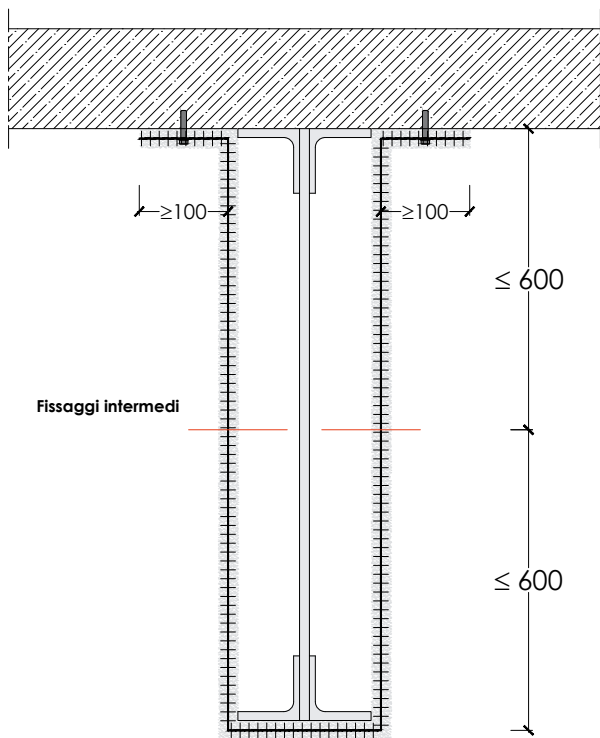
Schema di applicazione per protezione di trave reticolare in carpenteria metallica (applicazione a box)
